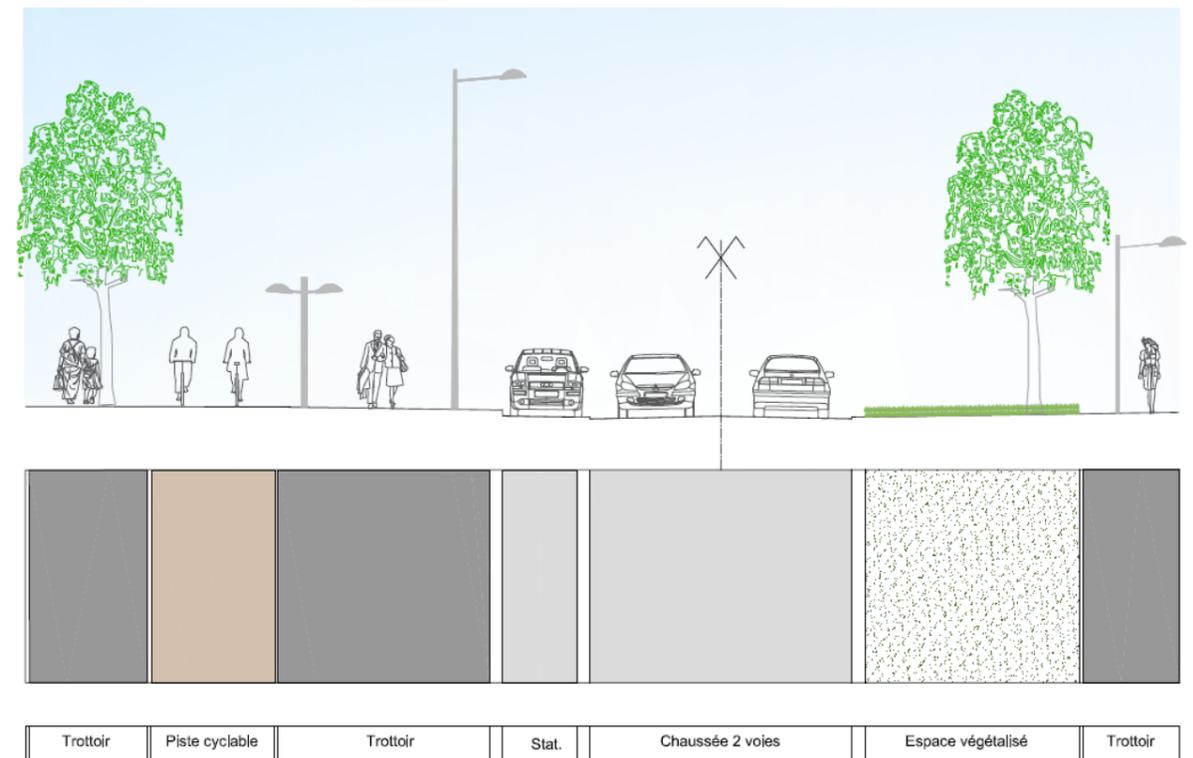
Coupe de principe sur le Boulevard Sud – Section 2
